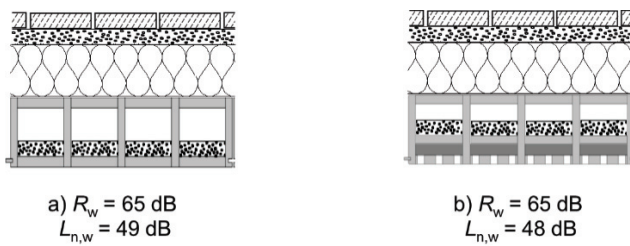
Flachdächer aus Massivholz-Kastenelementen, EPS Aufdachdämmung, Dachabdichtung und Betonplatten im Kiesbett:
